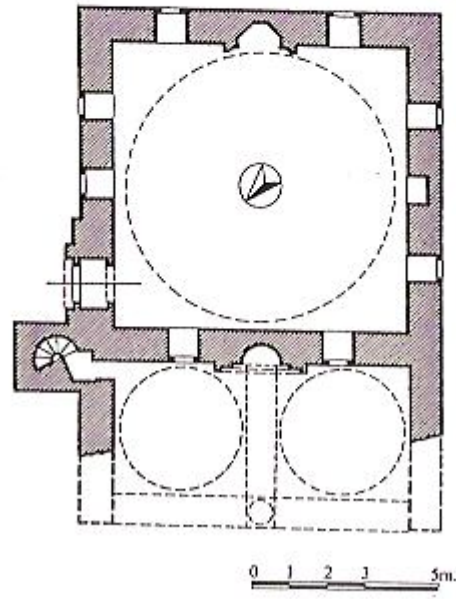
(Y.Özbek) Yıldırım Camii planı
